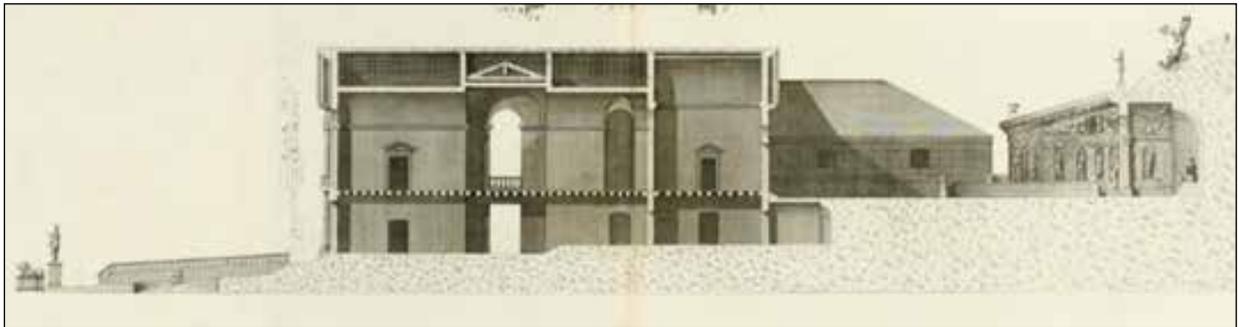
Corte longitudinal da Villa Barbaro. Fonte: SCAMOZZI, O.B. The buildings and designs of Andrea Palladio. Princeton Architectural Press. NY. 2015. p. 214-215.
